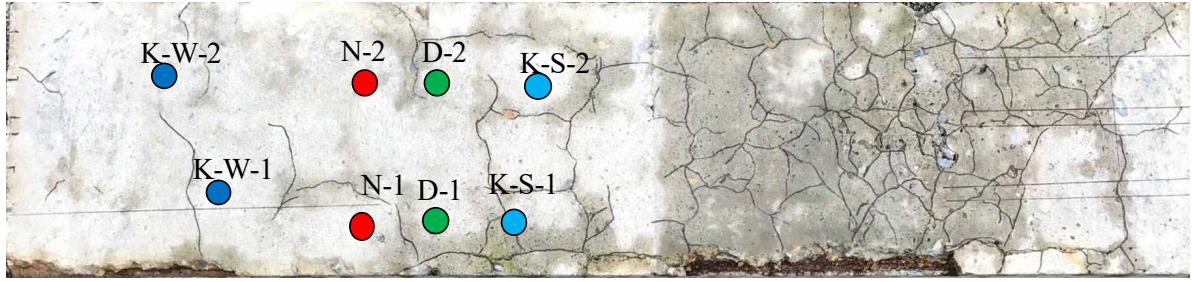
老朽化した RC 床版の損傷状況と柱状サンプル採取位置
